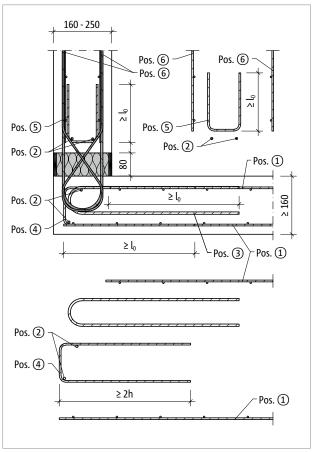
Schöck Isokorb® T tipo AP: disposizione verticale, armatura in opera
